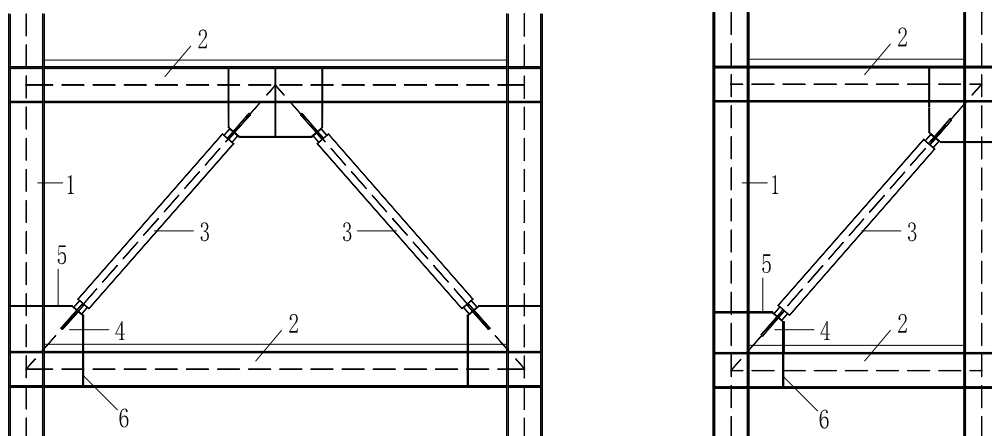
钢构件与屈曲约束支撑连接示意
